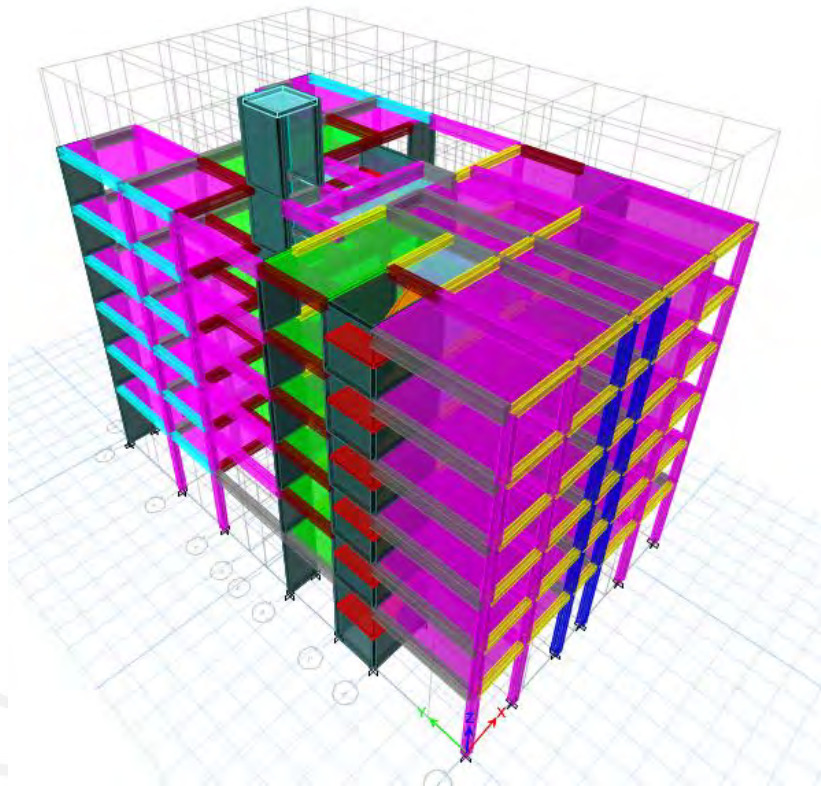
VISTA EN 3D DEL MODELO ESTRUCTURAL.
